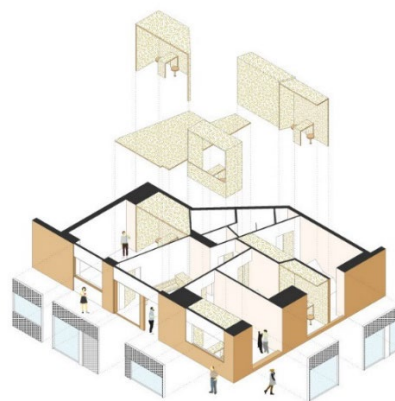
Vista interior e Ilustración 37 – Axonometría (Fuente: Archdaily)
